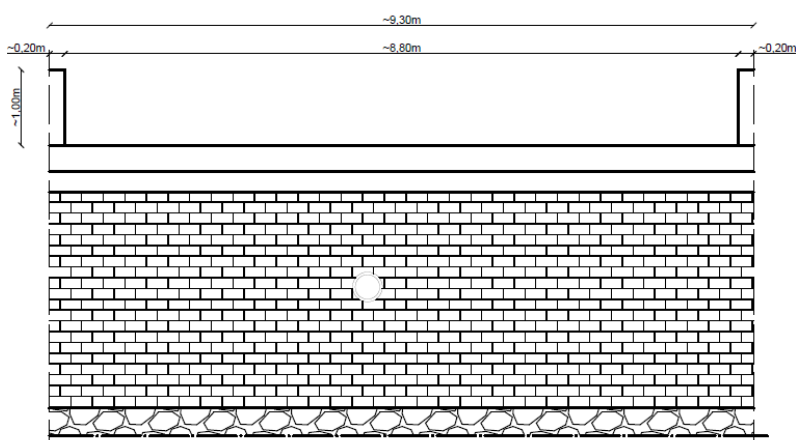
Prospetto e sezione del Ponte di via Cornaro
